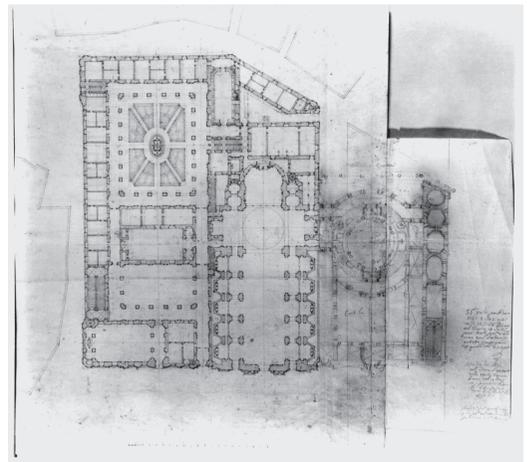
フランчесコ・ボッロミーニによるオラトリオ会の施設全体の計画案（地上階の平面図） Alb. 285, Wien (1636-1637年) 教会堂の右側は1644年にデザインを付加
